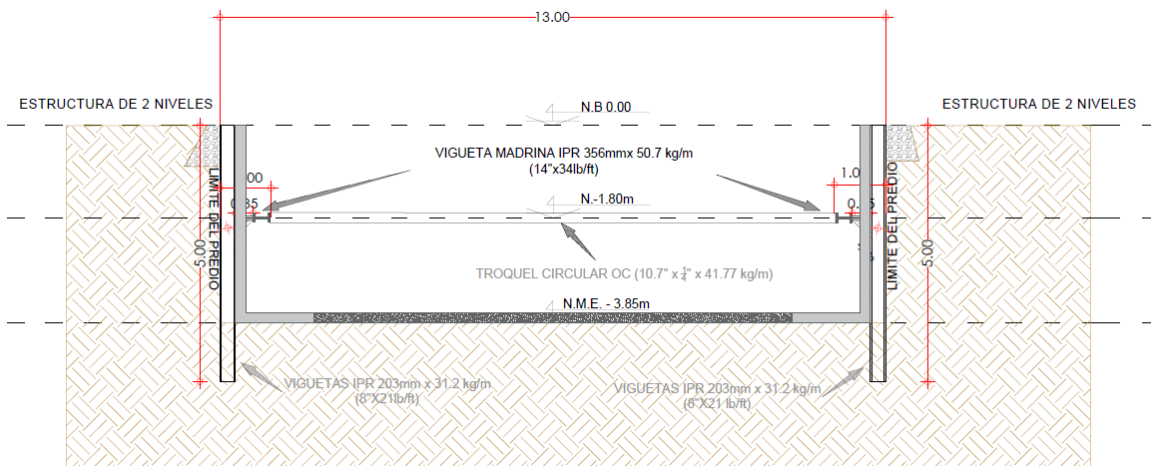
CONSTRUCCIÓN DE LA CIMENTACIÓN Y MUROS PERIMETRALES
